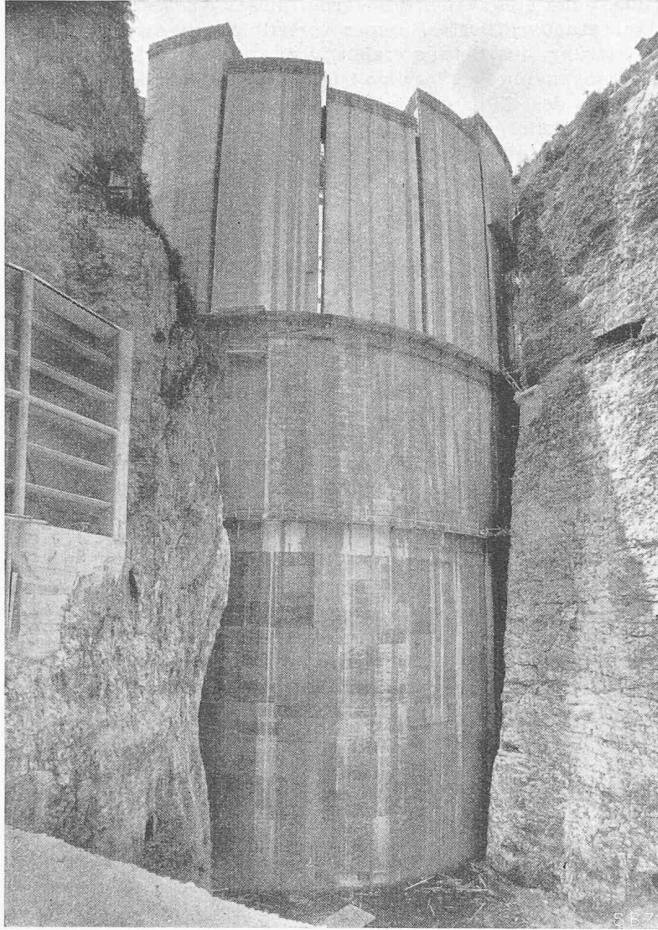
Wasserseitige Ansicht der Bogen-Staumauer S. Giustina; Bauzustand Juli 1949
